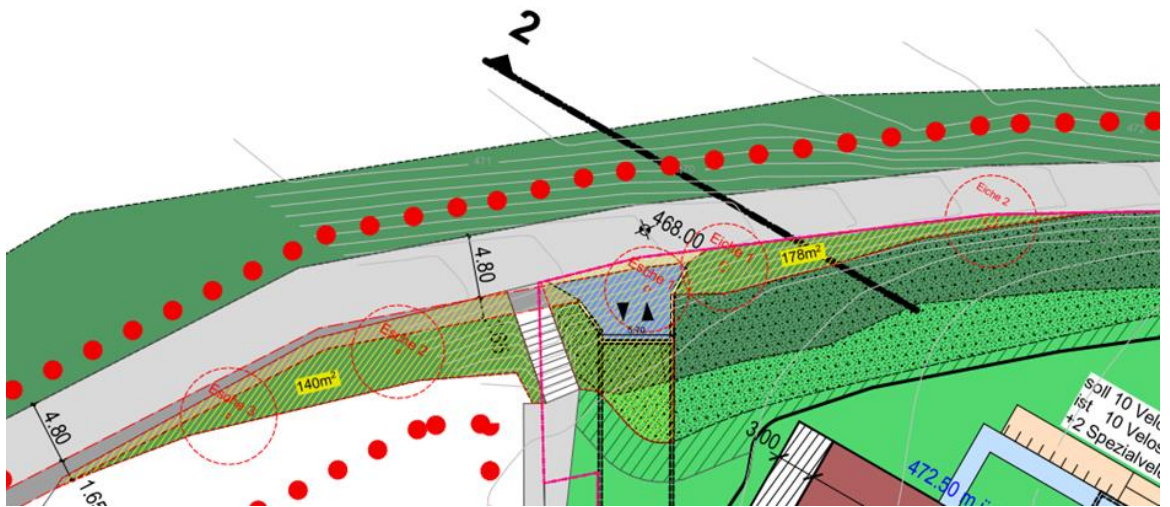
Ausschnitt aus Detailbebauungsplan Stockacker, Stand 21.01.2021, Raess Architekten (gelb schraffiert sind die, von der Entfernung betroffenen Heckenflächen).
